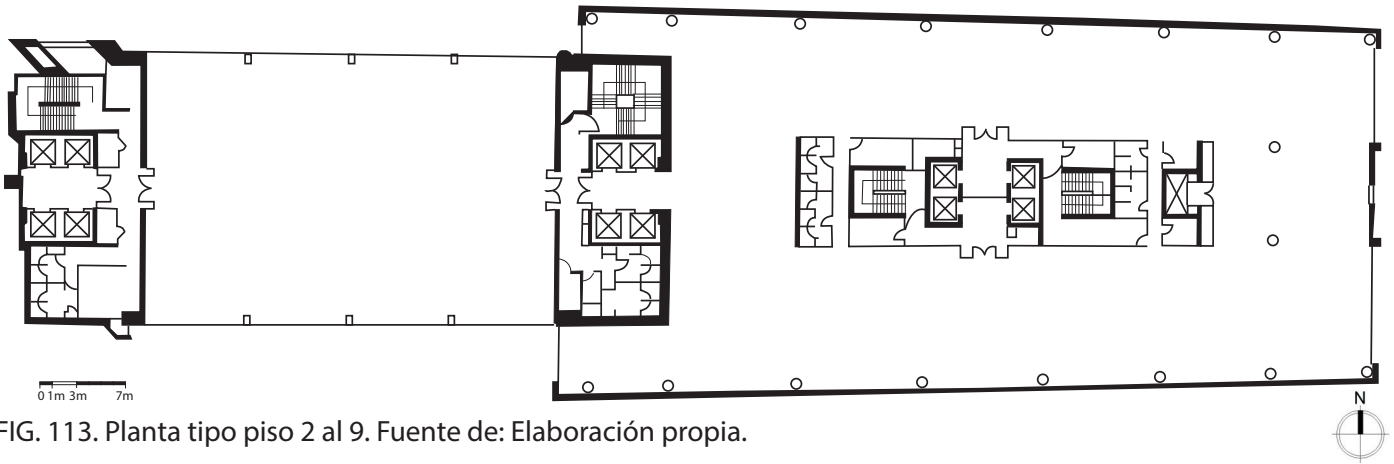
Planta tipo piso 2 al 9. Fuente de: Elaboración propia.
